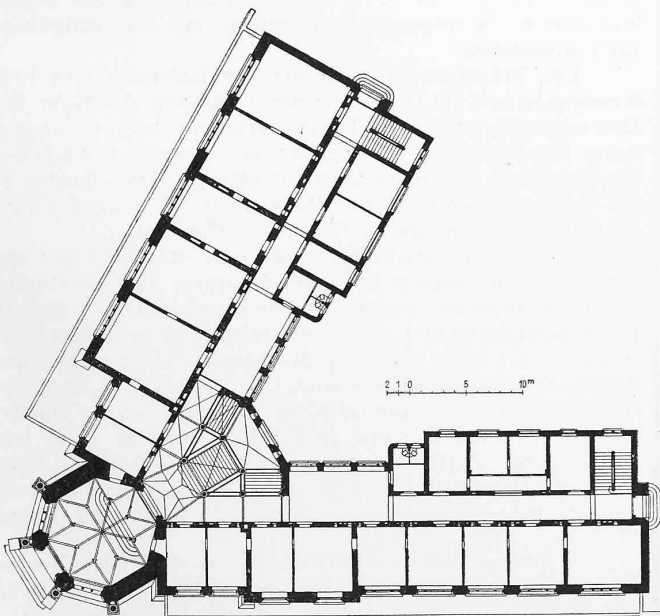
Grundriss vom Erdgeschoss.
